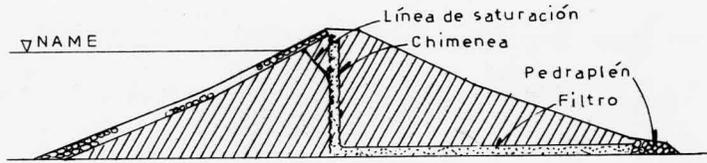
Sección de cortina homogénea con filtros vertical y horizontal.
